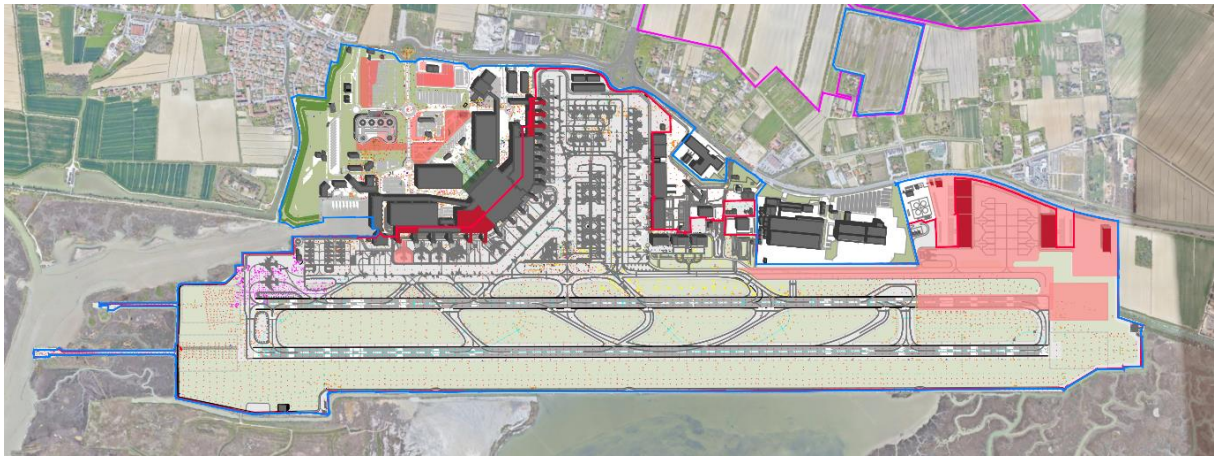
Aggiornamento Masterplan – Fase 3 – 2037 (Estratto SIA)
